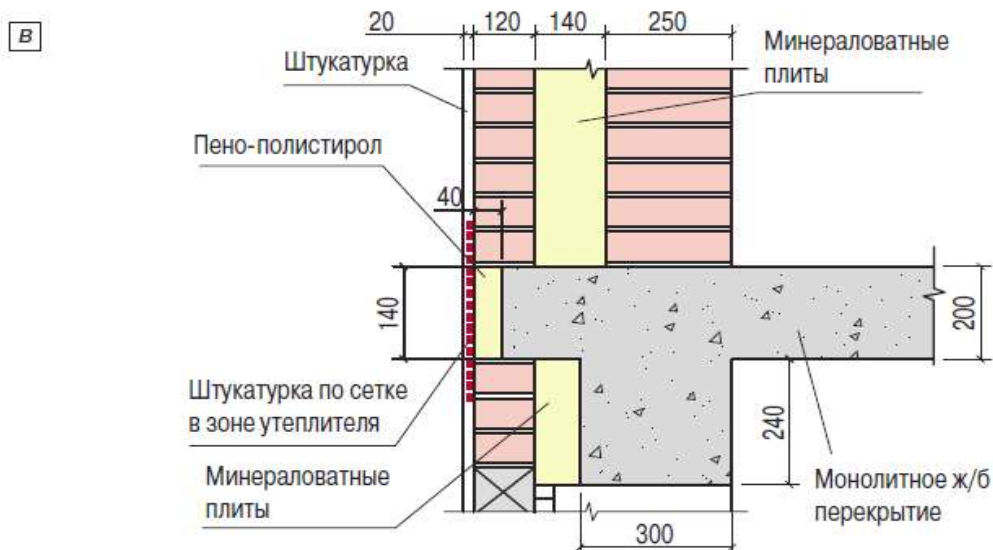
в. Жилой дом на ул.Плющиха в Москве. Узел опирания лицевого слоя кладки с плитой перекрытия
